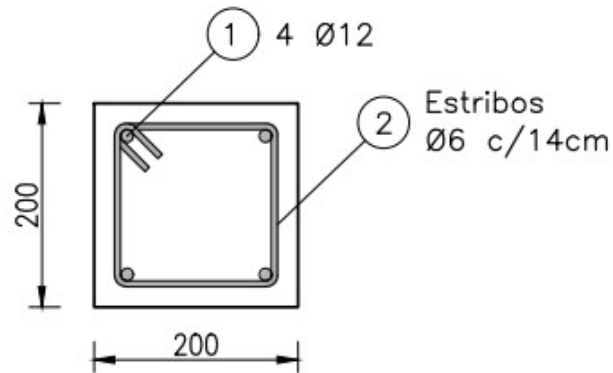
Armaduras columnas 20 cm x 20 cm
